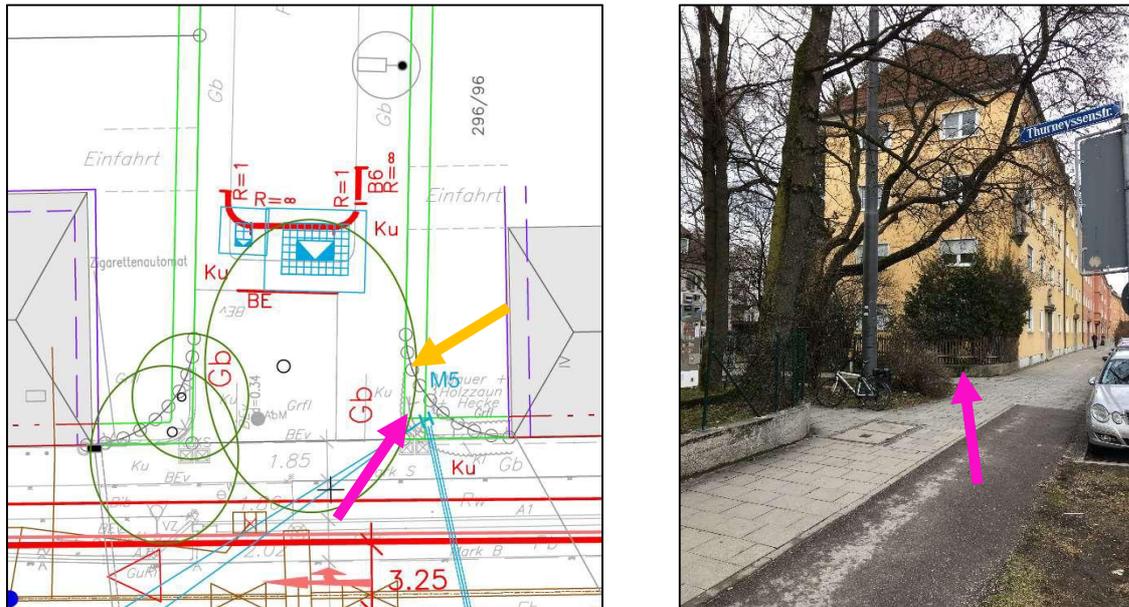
Einmündung Thurneysenstraße: Ausschnittvergrößerung Entwurfsplan zur Unterlage 3.16 (links) und Foto (rechts)
